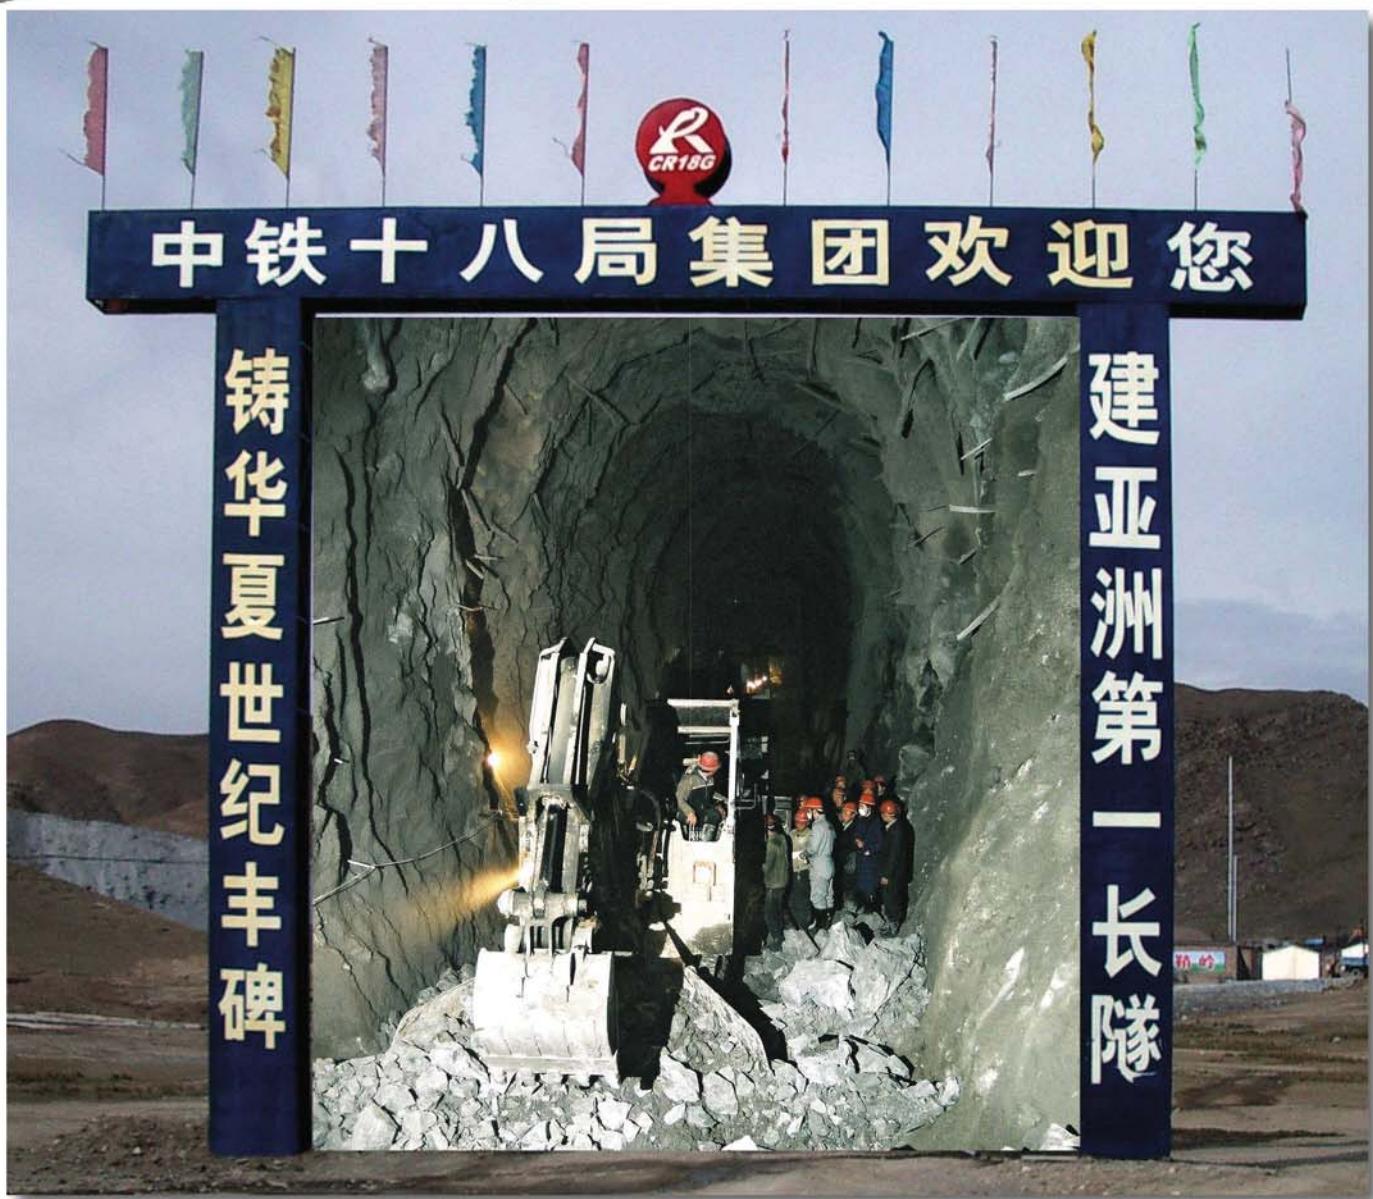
«Chinesisches Gedicht» Der längste Tunnel Asiens; Bau des Tunnels in China; Willkommen in Baubüro 18.
